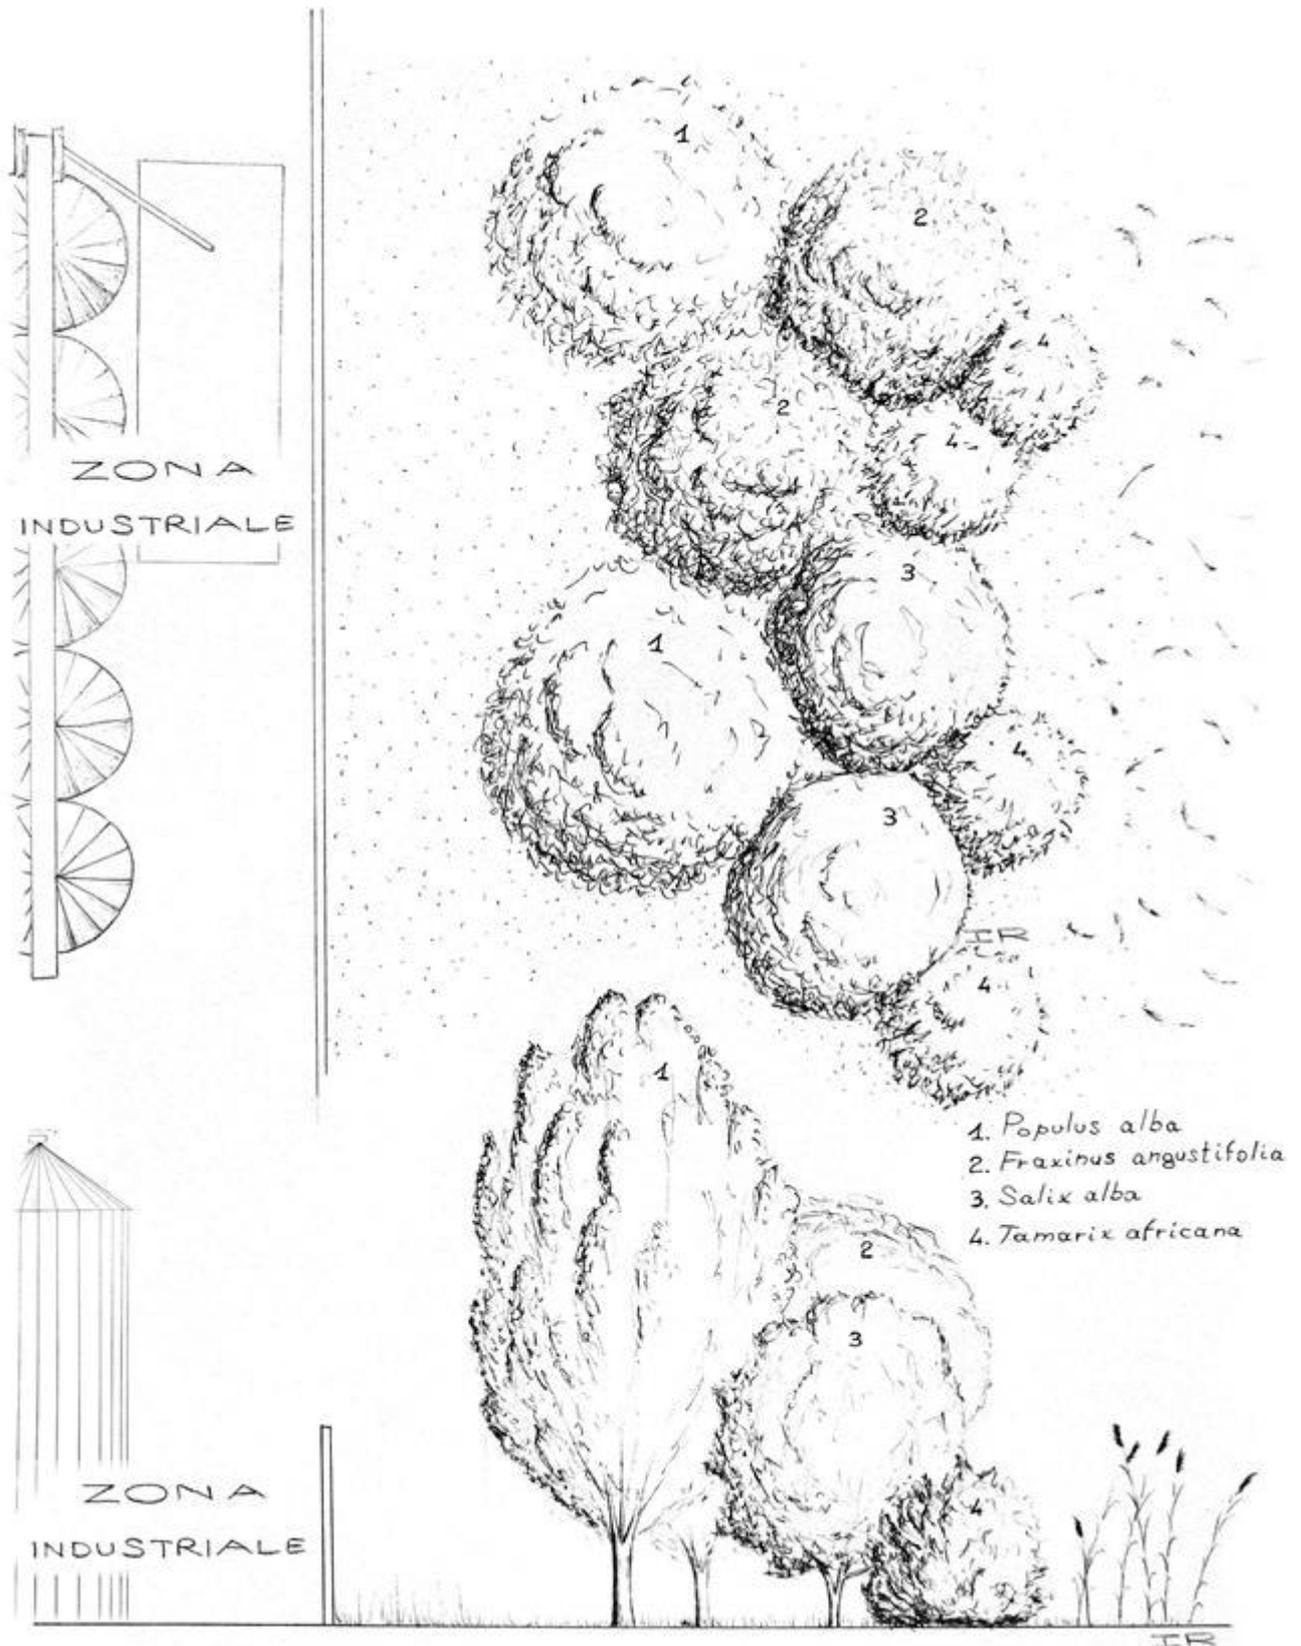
Schema generale di un tratto di area filtro (pianta e sezione tipo).
